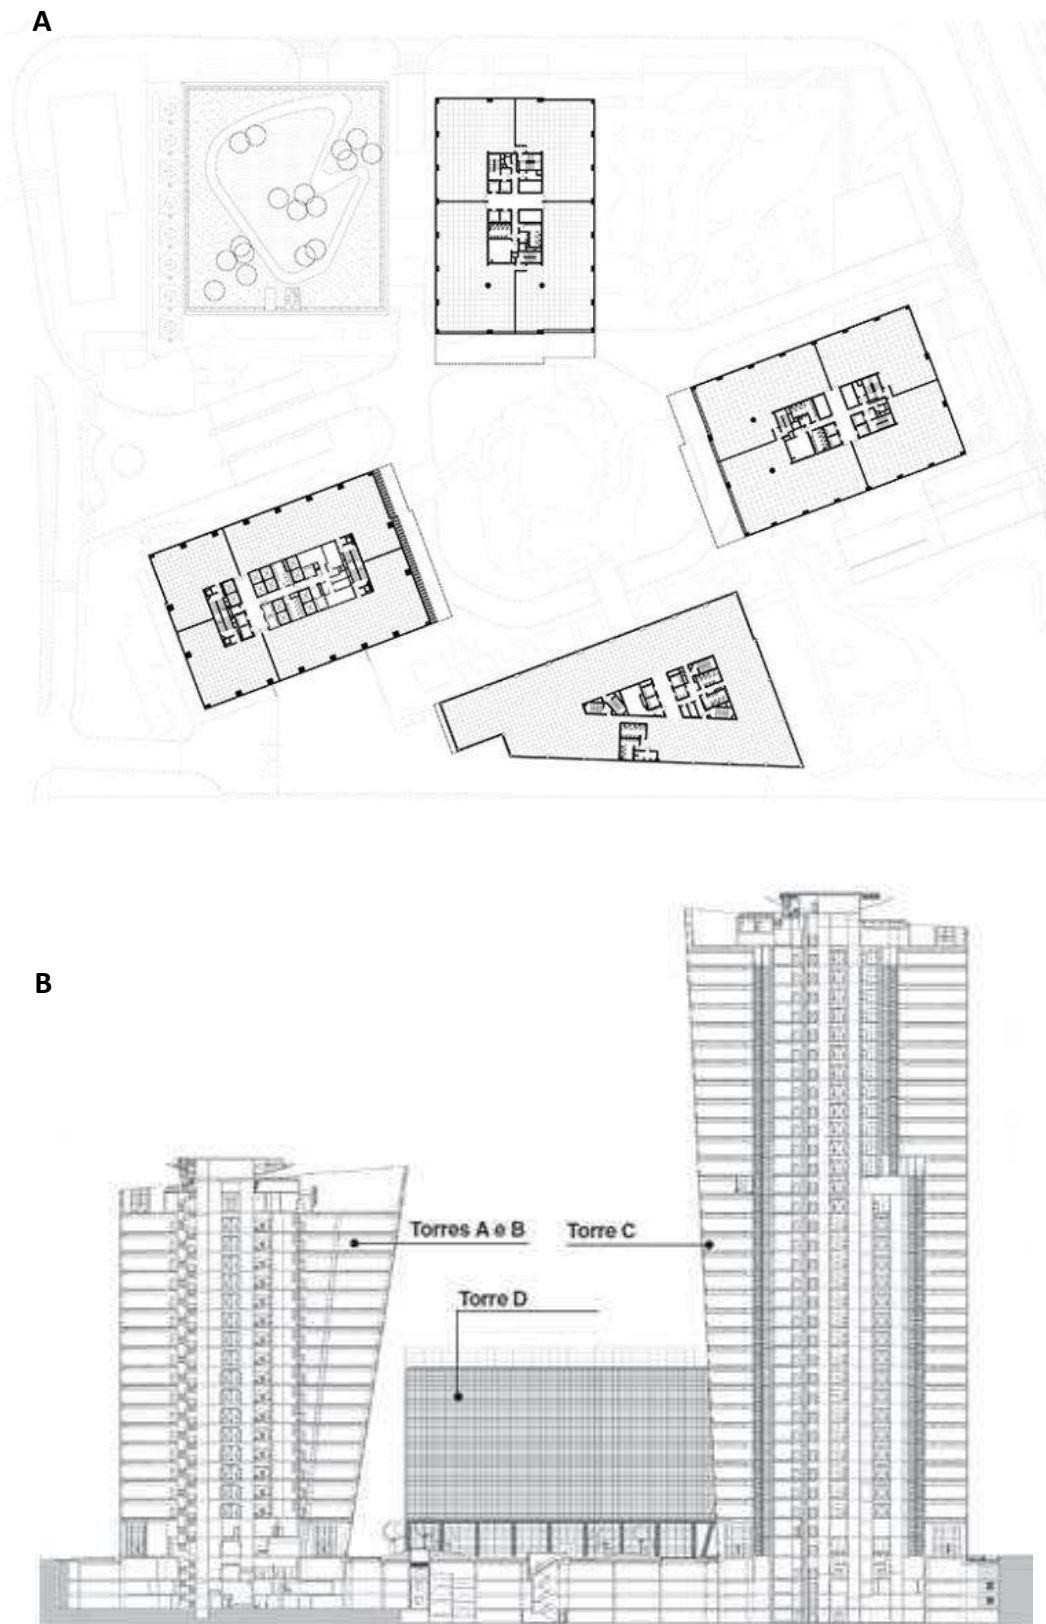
Projeto Rochaverá Corporate Towers. A: Plantas baixas dos pavimentos tipos das 4 torres e planta de cobertura do Edifício Garagem, B: Corte do Projeto do Rochaverá Corporate Towers. Fonte: <http://www.purarquitectura.arq.br/projeto.php?id=>
